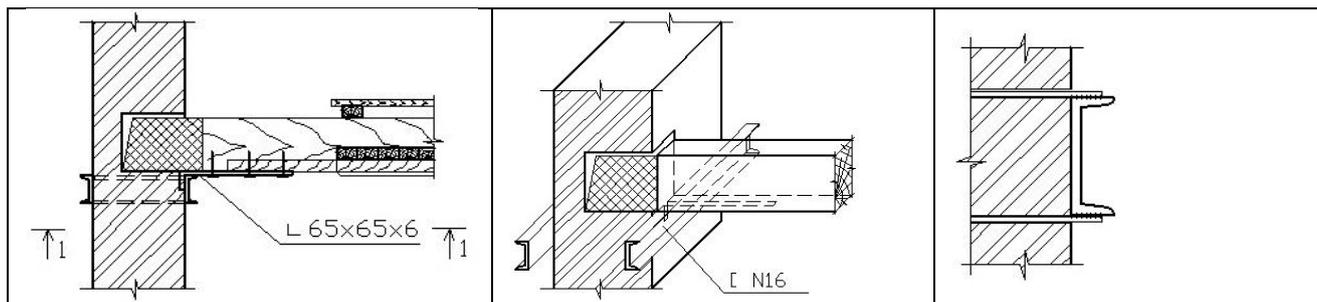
Устройство металлического сейсмопояса в зданиях с деревянными перекрытиями при отсутствии поясов.
